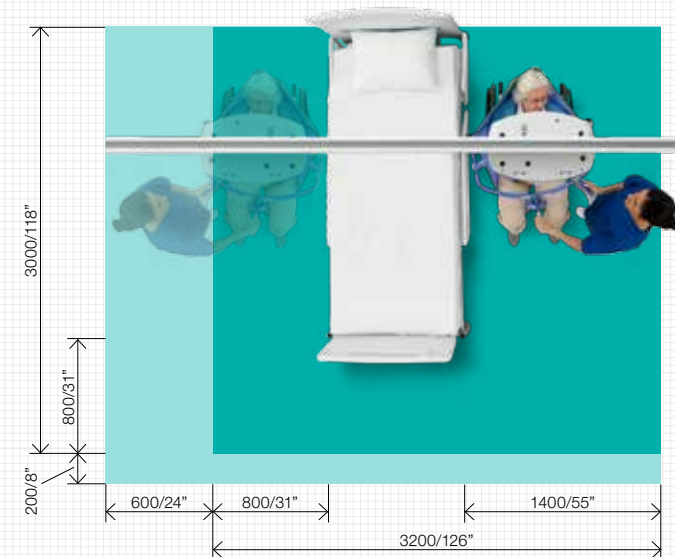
DORIS ED EMMA - Trasferimento generico, sollevatore a soffitto
